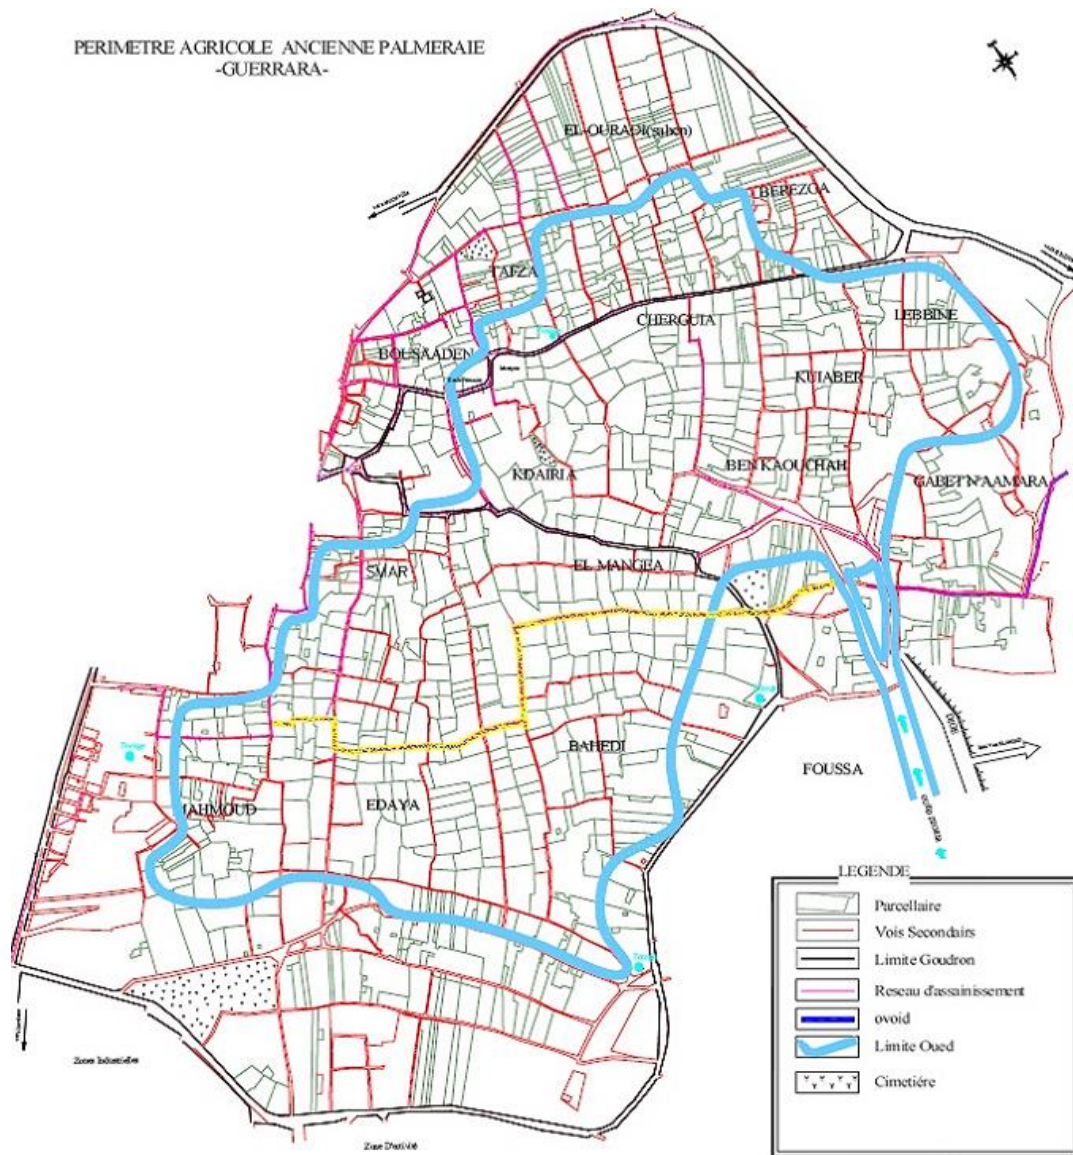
Le plan du réseau d'assainissement de Guerrara
